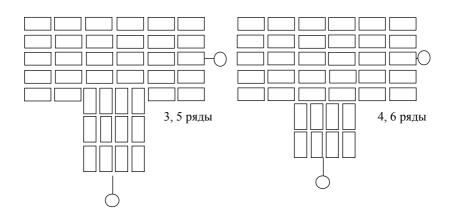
Кладка примыканий стен толщиной в 2,5 и 2 кирпича
